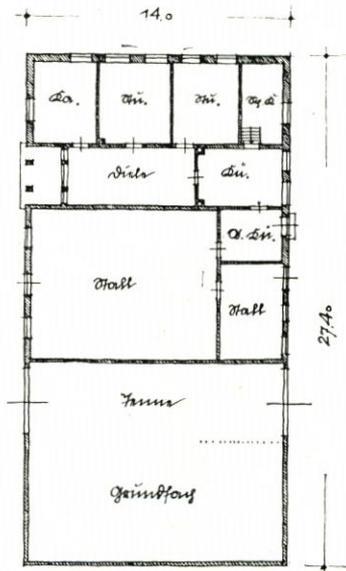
Grundriß der 14 ha-Stelle im Dieksanderkoog
